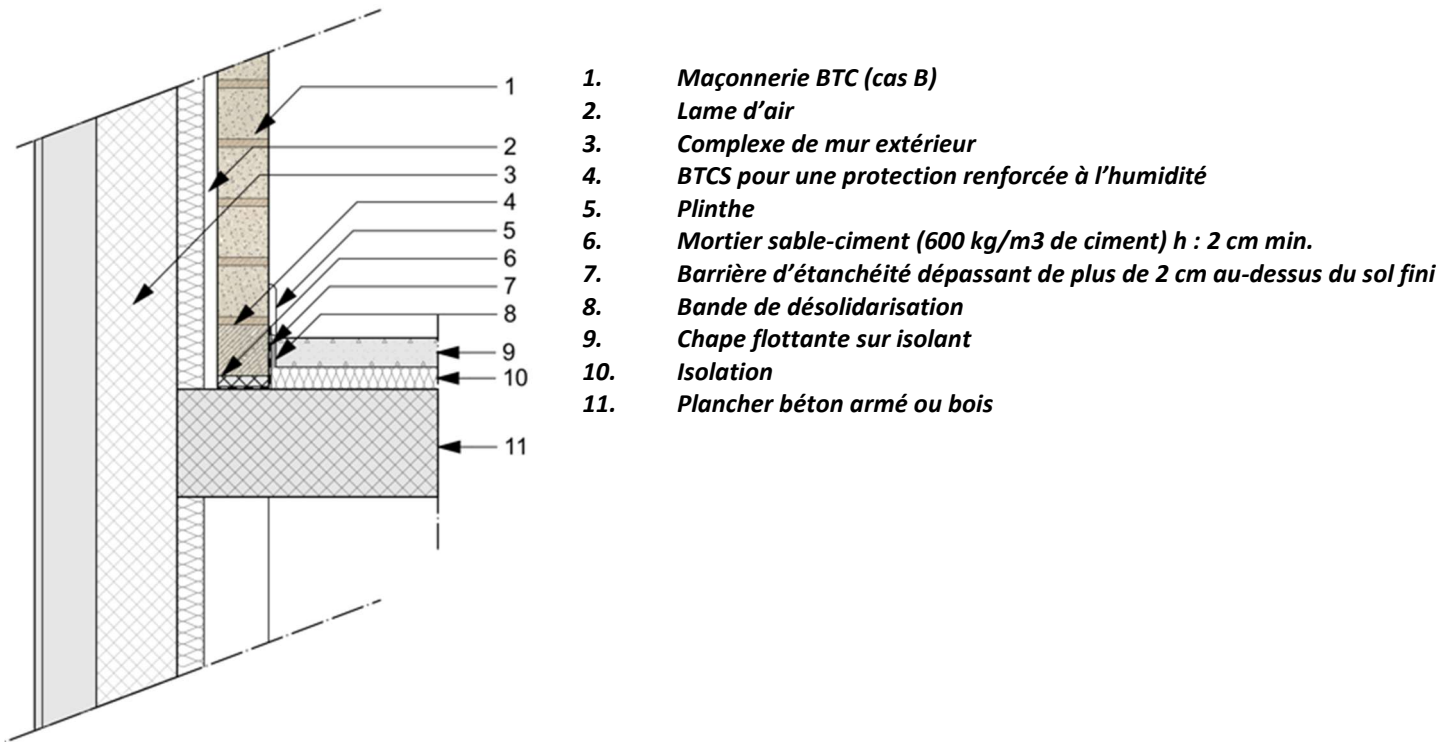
Exemple de jonction au niveau du plancher avec chape flottante (cas B)
